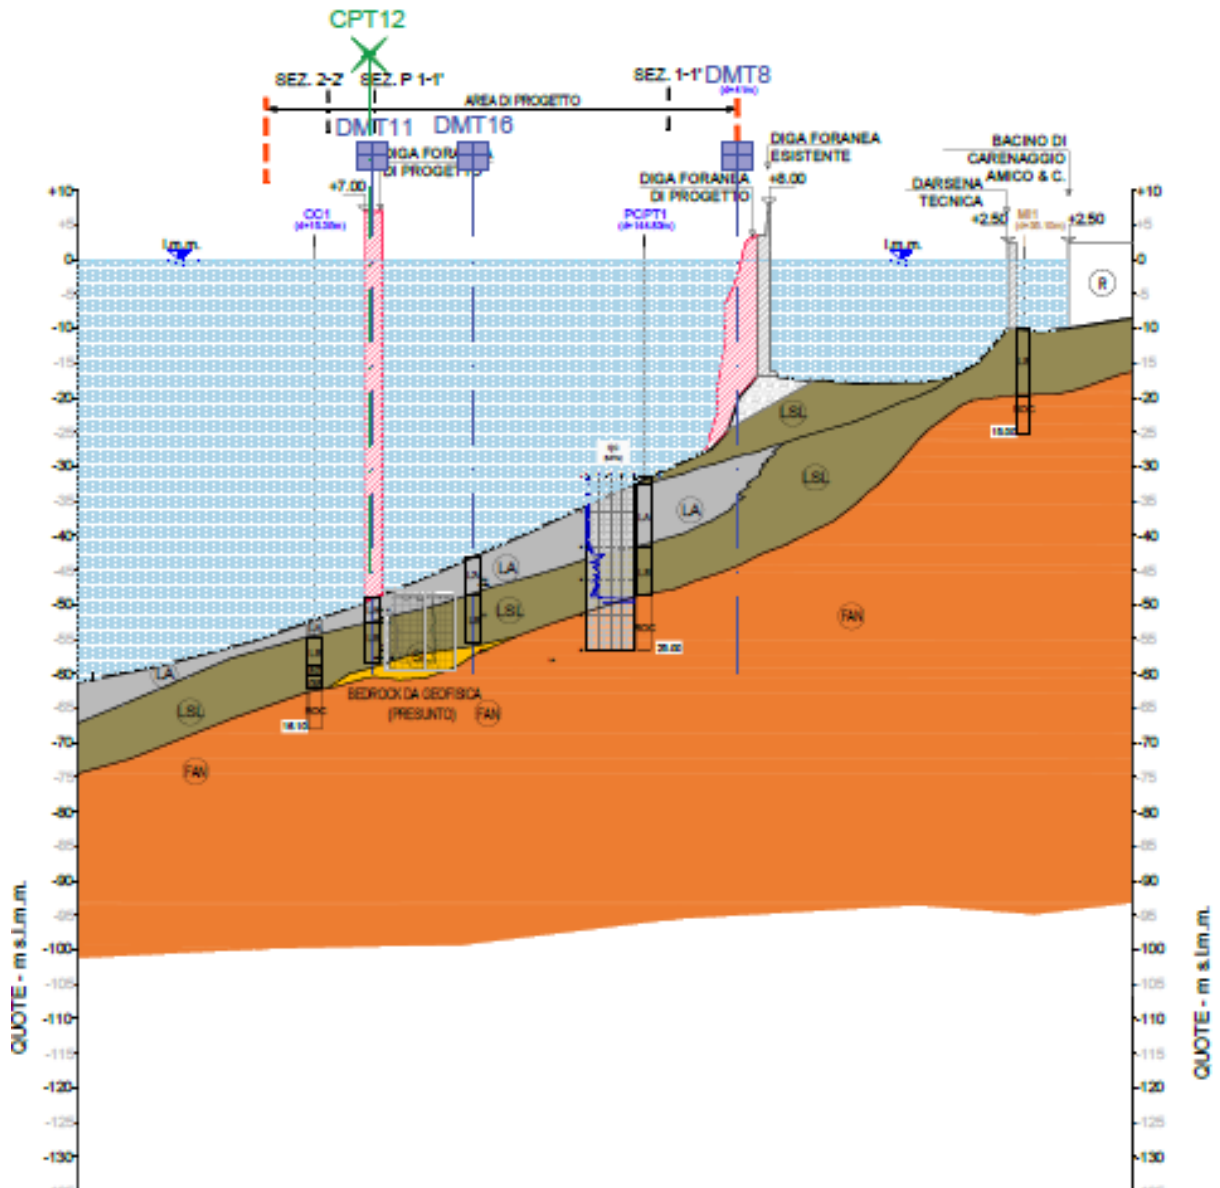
Sezione geotecnica di calcolo 7-7'
